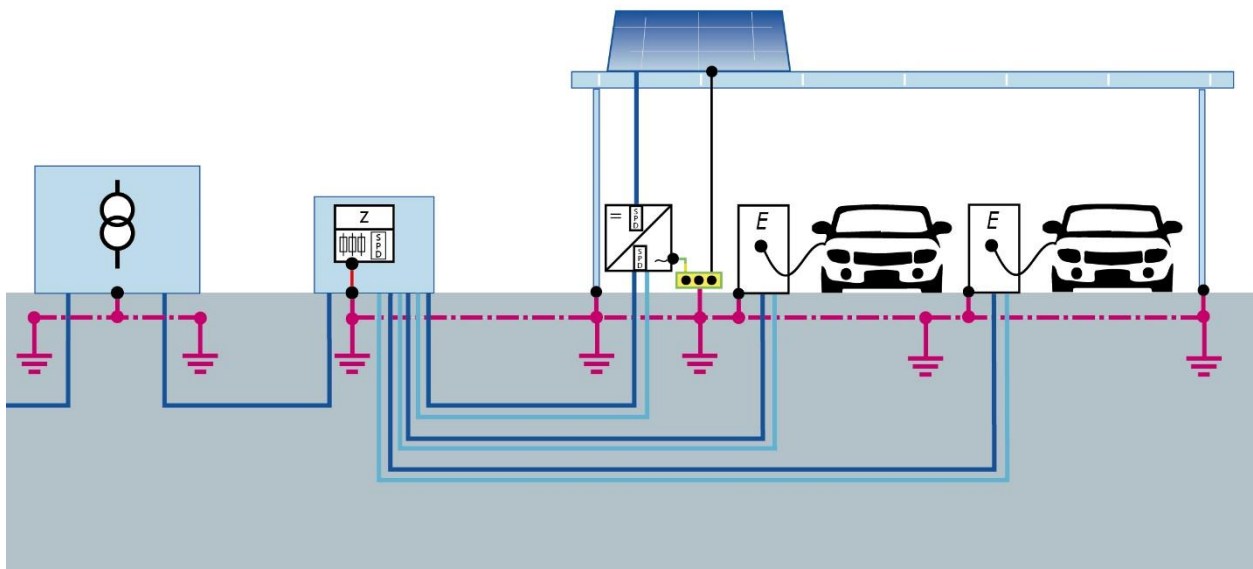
Ein Netzanschluss mit Erdungsanlage auf einem Grundstück – Beispiel Ladepark mit metallener Überdachung und PV-Anlage versorgt aus Ortsnetzstation
